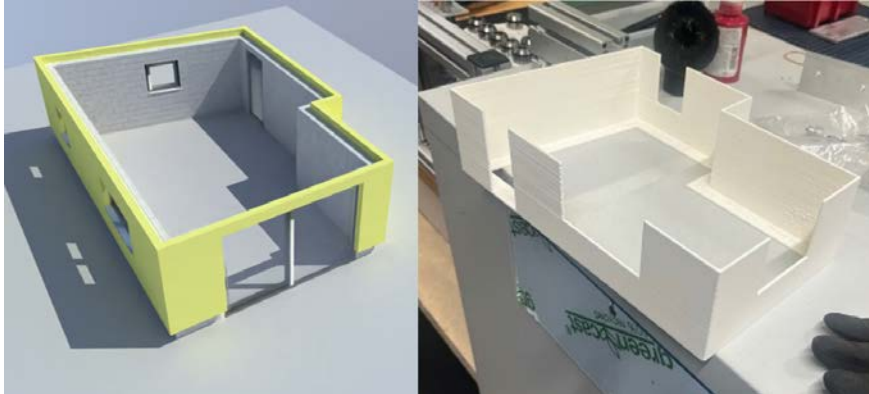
Beispielhafte Darstellung eines studentischen 3D-Druckmodells, links: BIM Modell Grundriss, rechts: gedruckter Grundriss.
